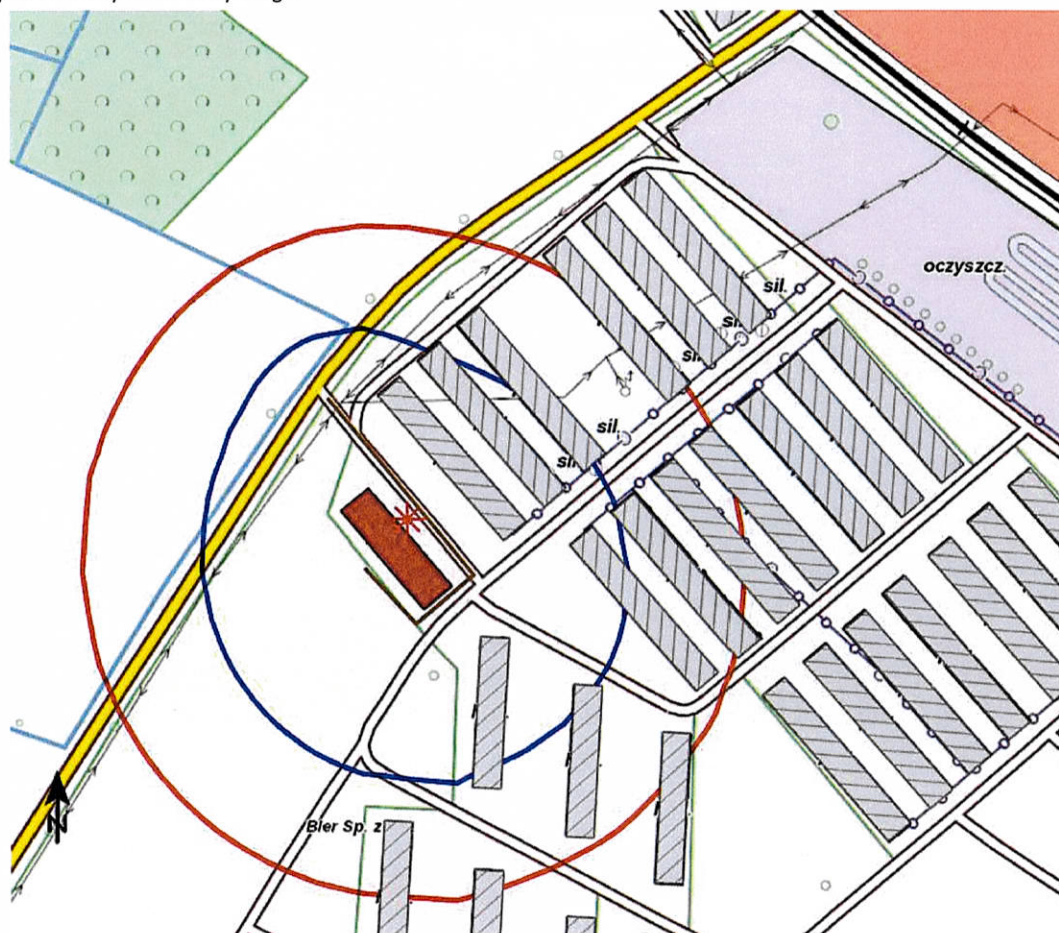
Plan zagospodarowania przedsięwzięcia.
